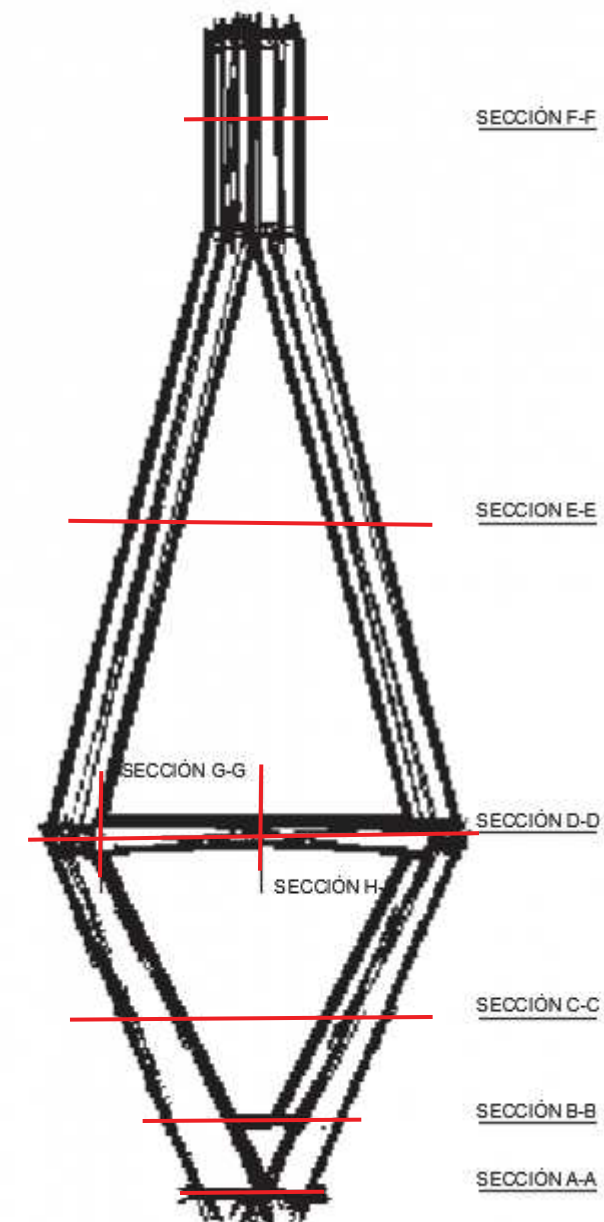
Definición de las secciones de cálculo para el armado del pilono
